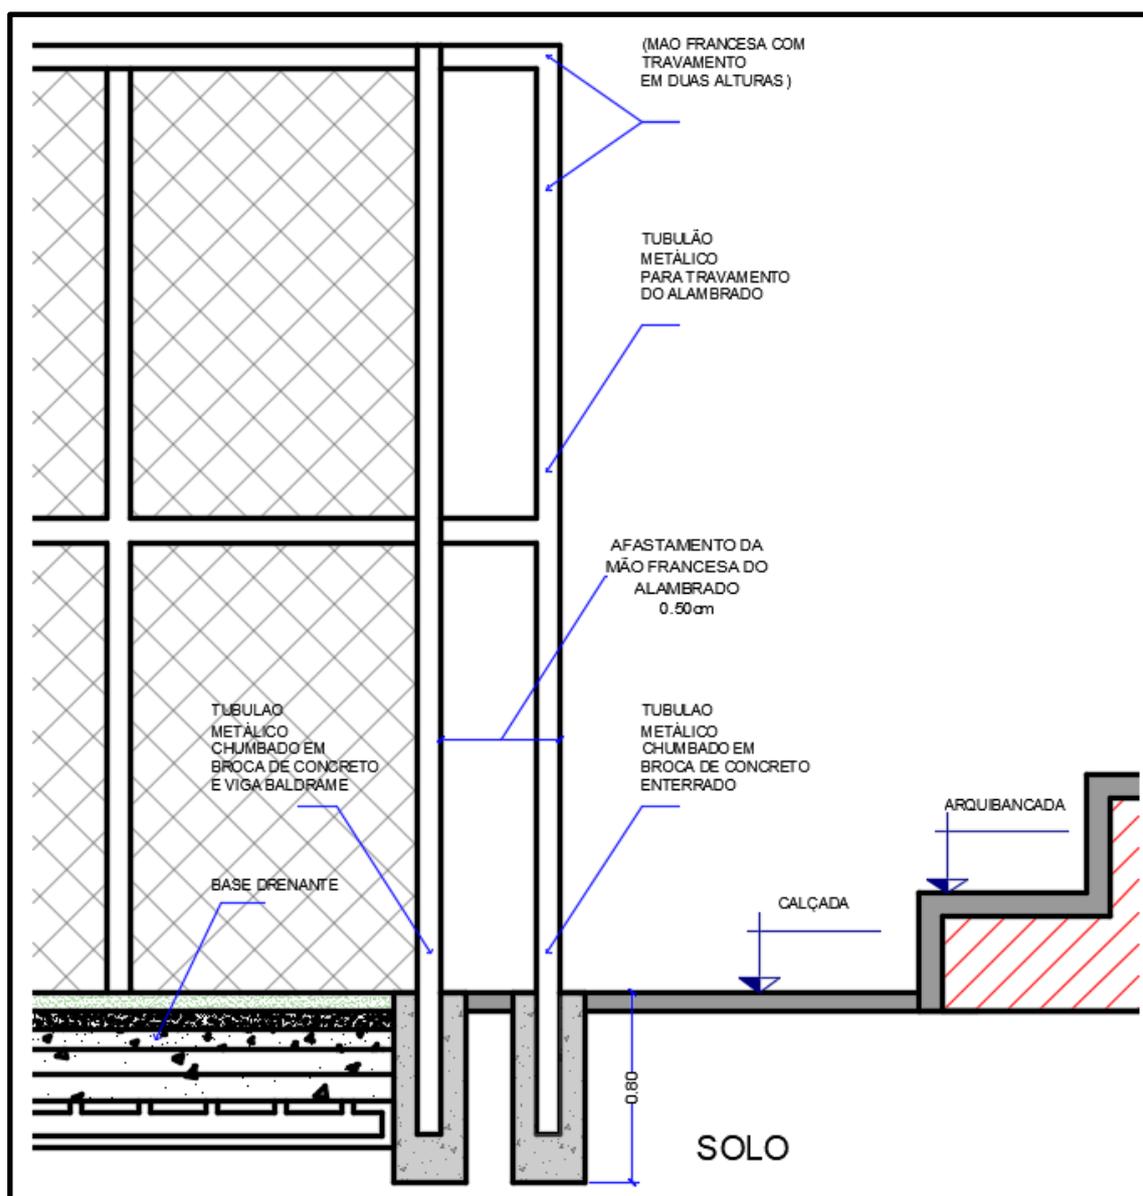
FIXAÇÃO DO ALAMBRADO – DETALHE RETIRADO DO PROJETO DE ARQUITETURA
